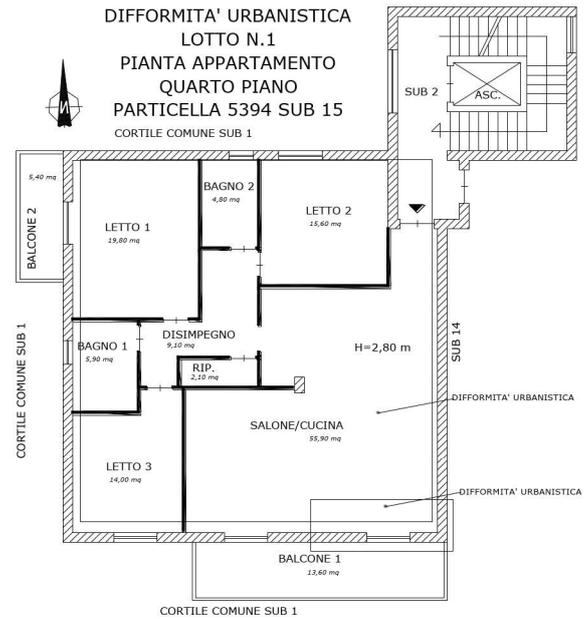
planimetria delle difformità urbanistiche dell'appartamento pignorato al quarto piano
